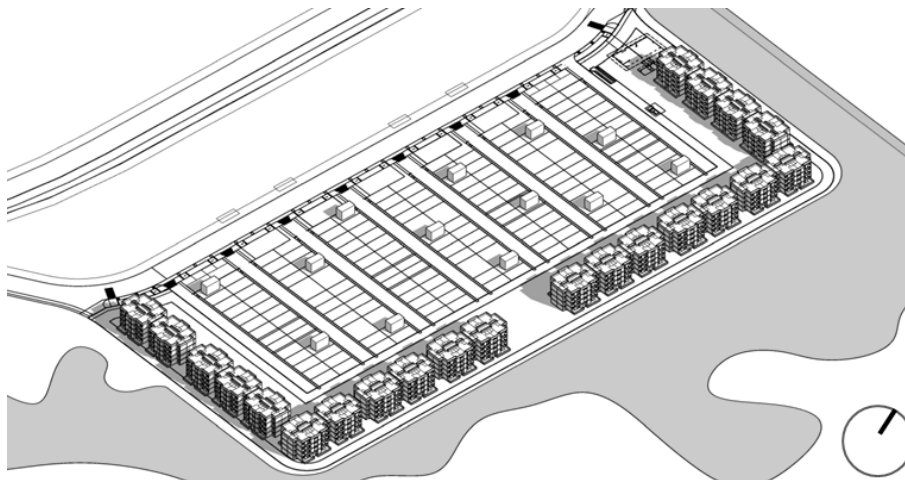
Emplazamiento proyecto Coral 11. Fuente: Prodesa
